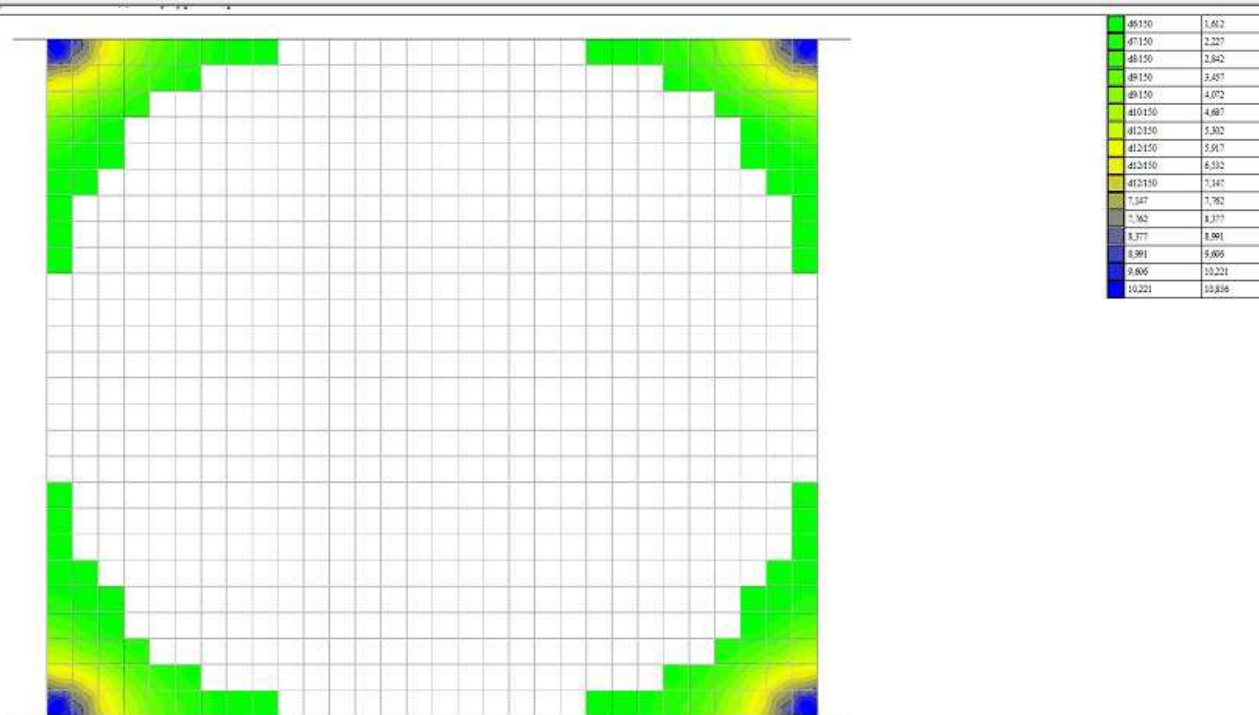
Схема верхнего армирования плиты по оси y
